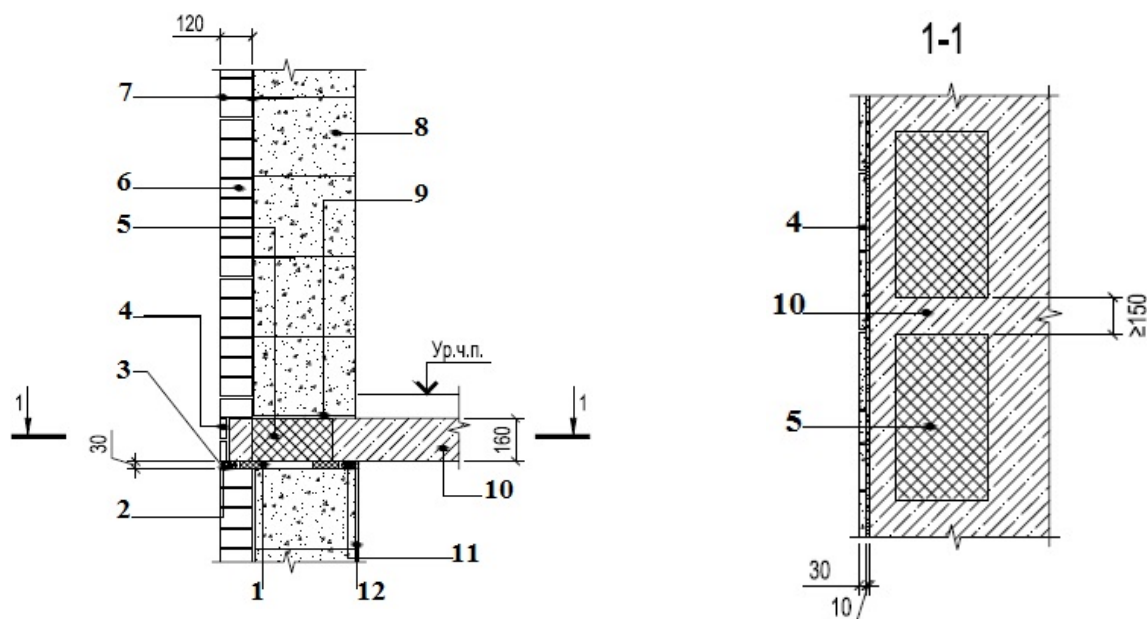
Наружная стена из газобетонных блоков с облицовкой и поэтажным опиранием на монолитное железобетонное перекрытие (каркасно-монолитное строительство):
